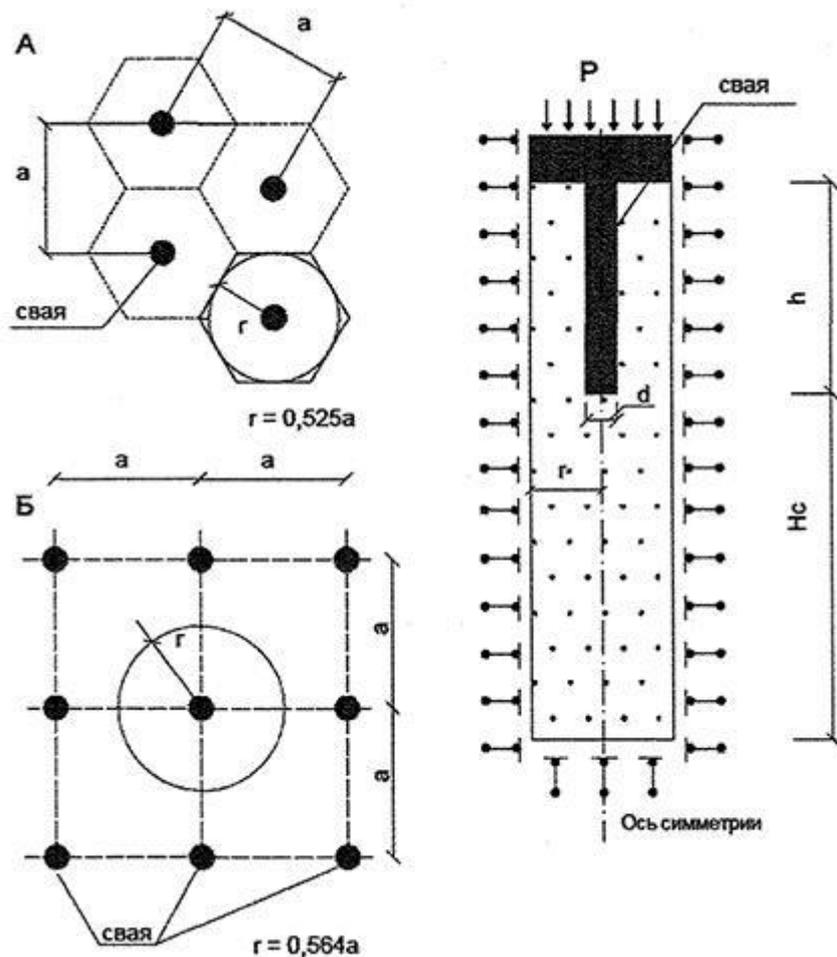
Расчетная схема метода ячейки
